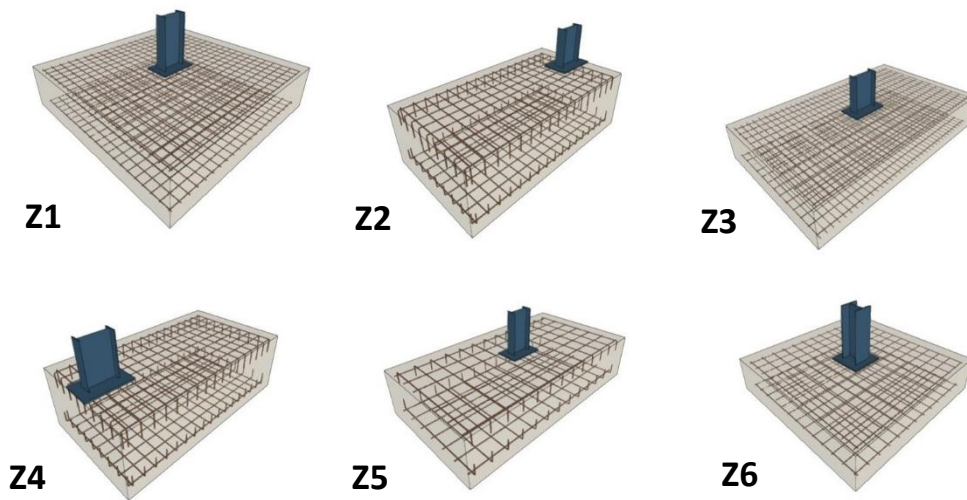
Vista 3D de las zapatas. Fuente: CYPE 3D.
